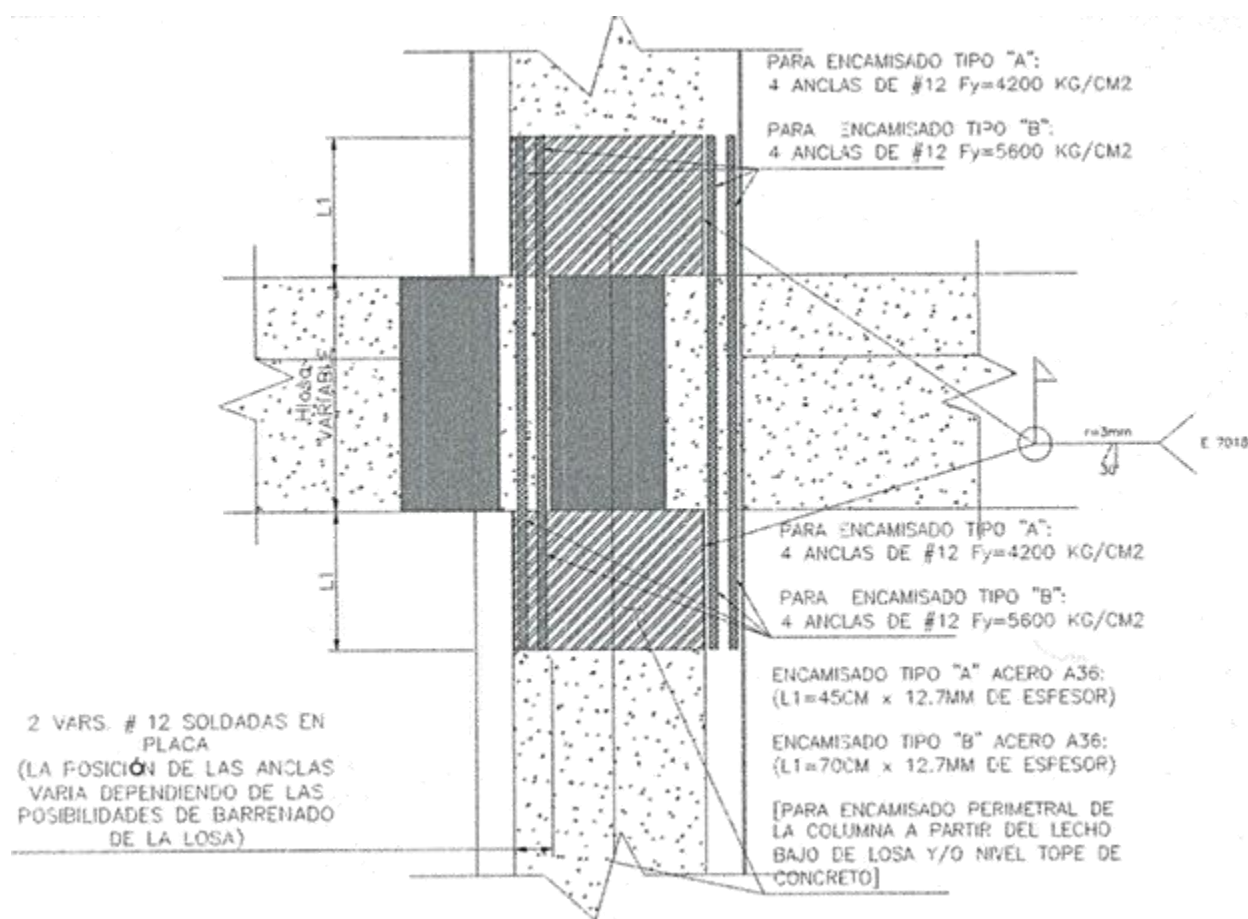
Continuidades de barras en el sistema de refuerzo del Proyecto Postensa, tomado de los planos estructurales proporcionado por Gómez González (2020).
